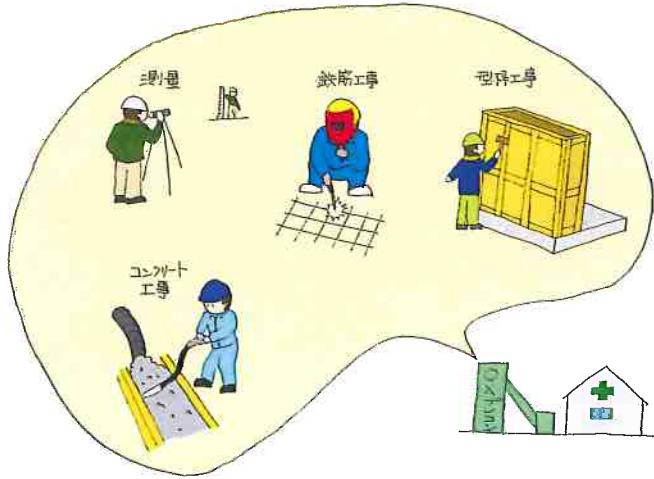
工事現場でのコンクリート施工は結構ややこしい
